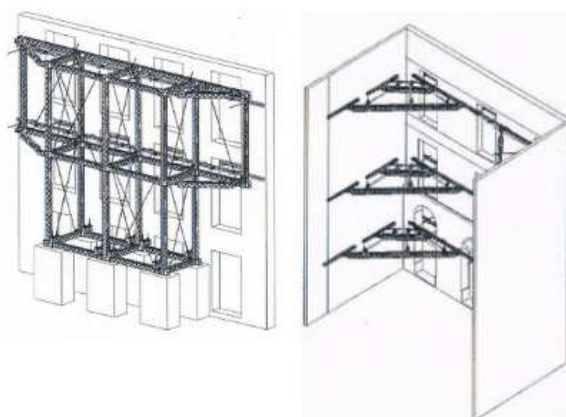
Estabilización de fachada mediante sistema Soldier (Fuente: <http://www.alquiansa.es>)
